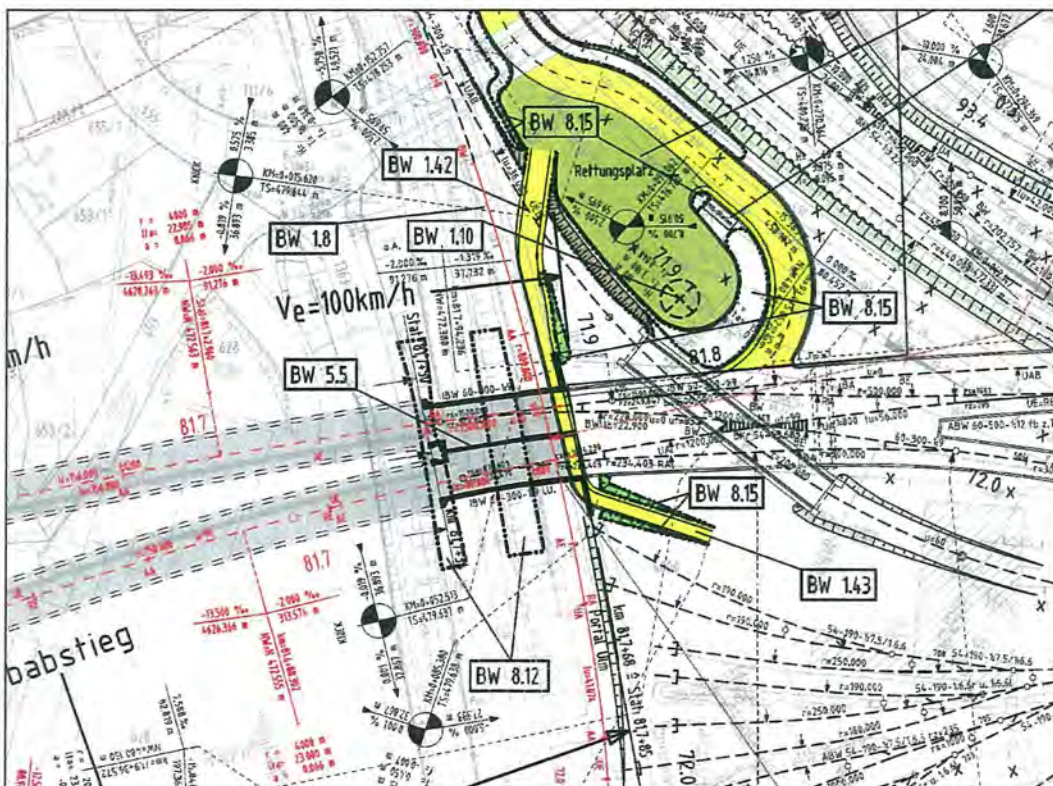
Lageplan (Ausschnitt) Portal Ulm [BGS06a]
